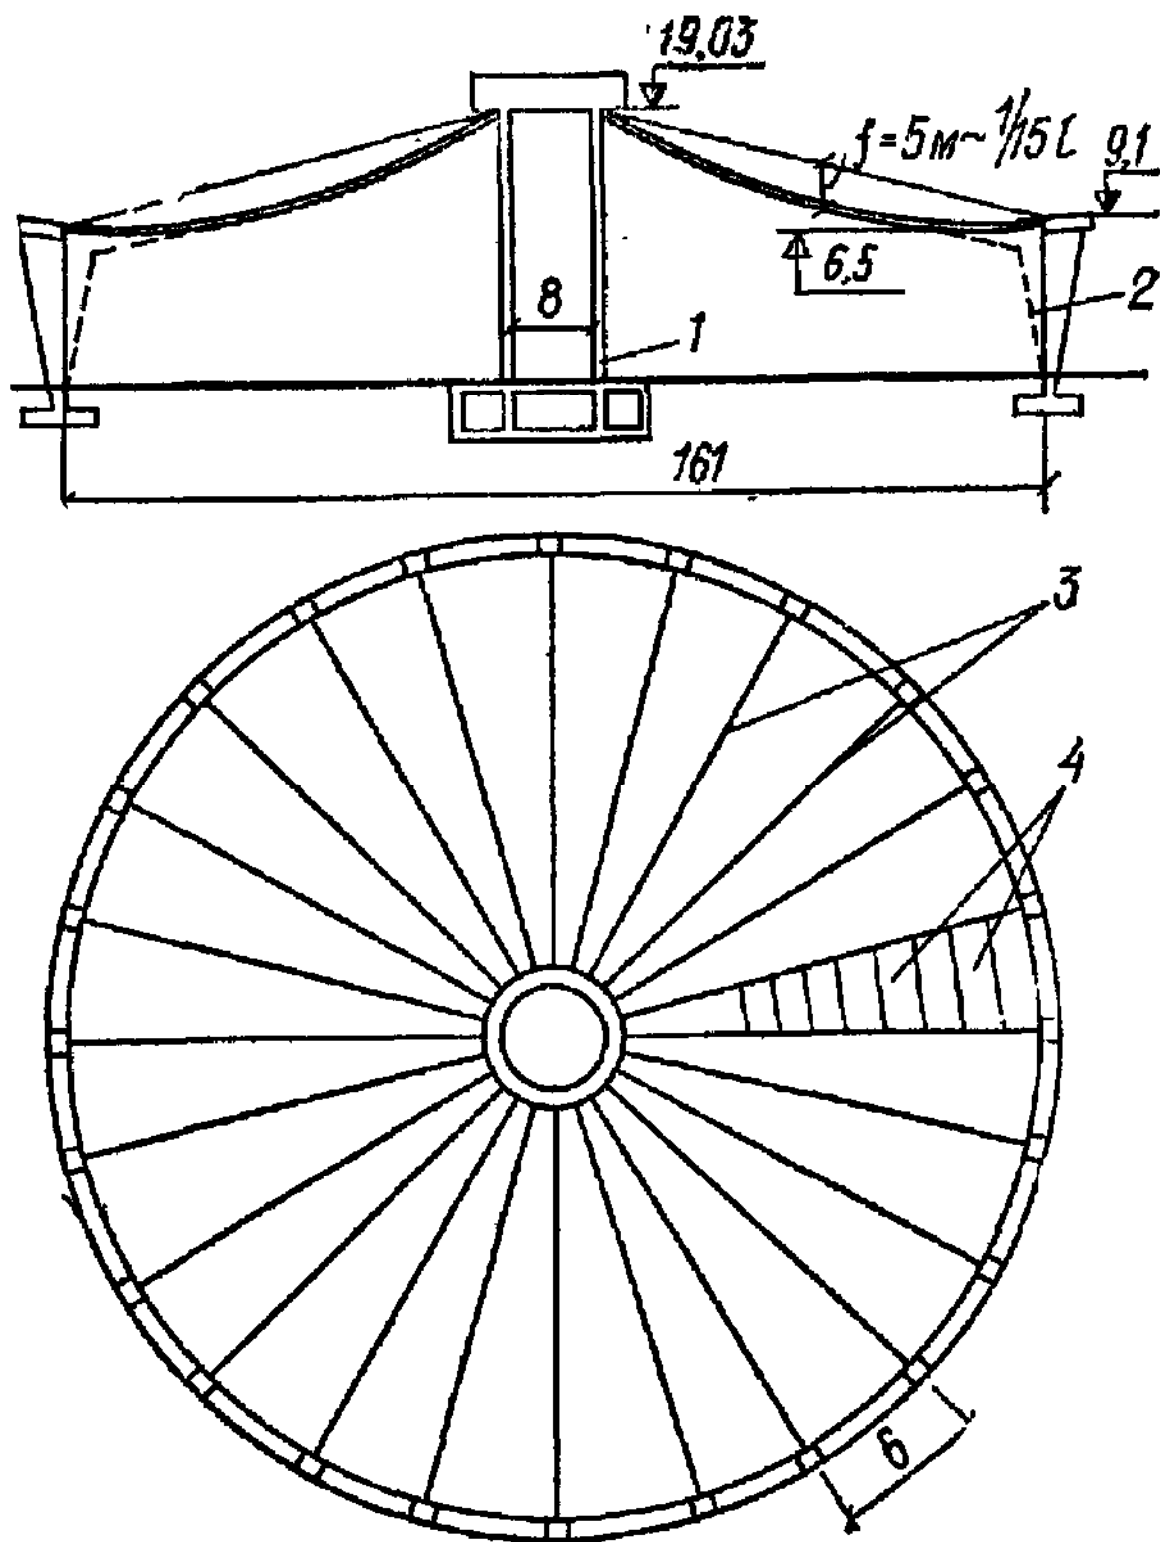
Покрытие гаража в Киеве: 1 – средняя железобетонная опора; 2 – водосток; 3- тросы 84 шт.  $\times$  65 мм; 4 – ребристые железобетонные плиты
